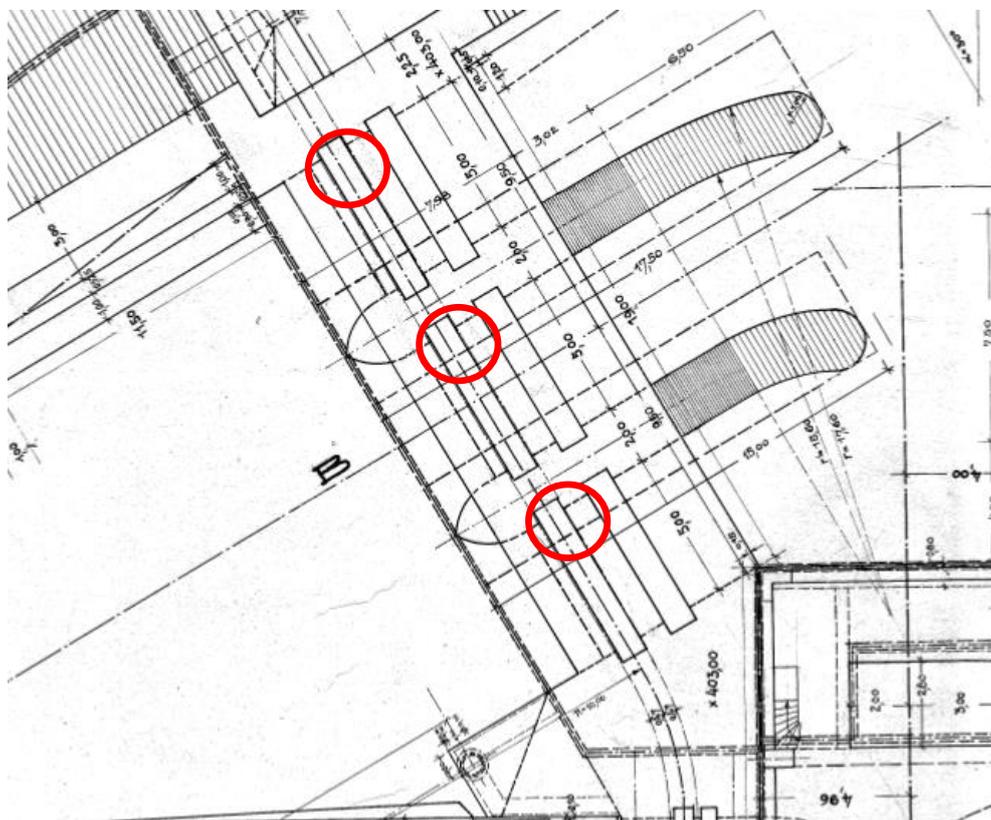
Grundriss Leerschuss WKW UP2
